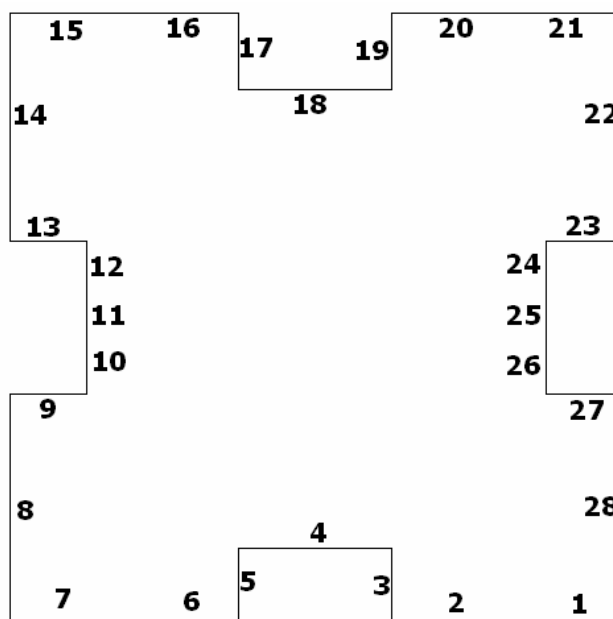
localização das paredes de concreto no pavimento utilizado como amostra
